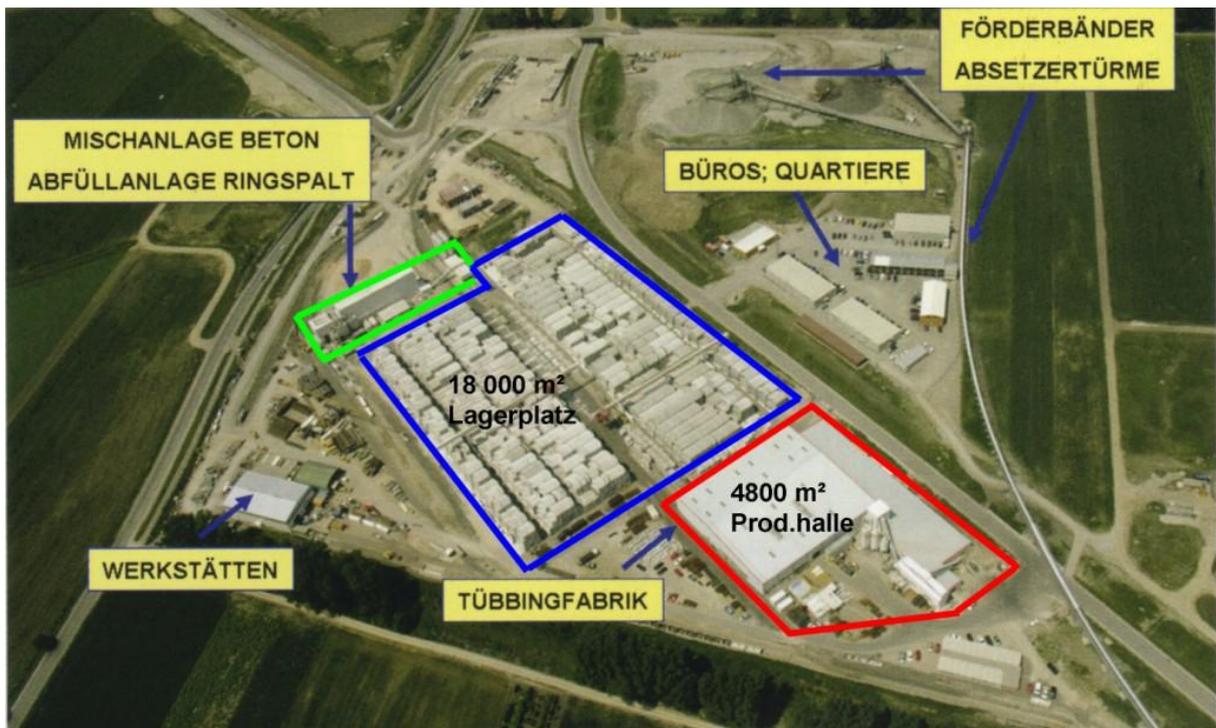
Baustelleneinrichtung Wienerwaldtunnel, Chorherr¹²³
